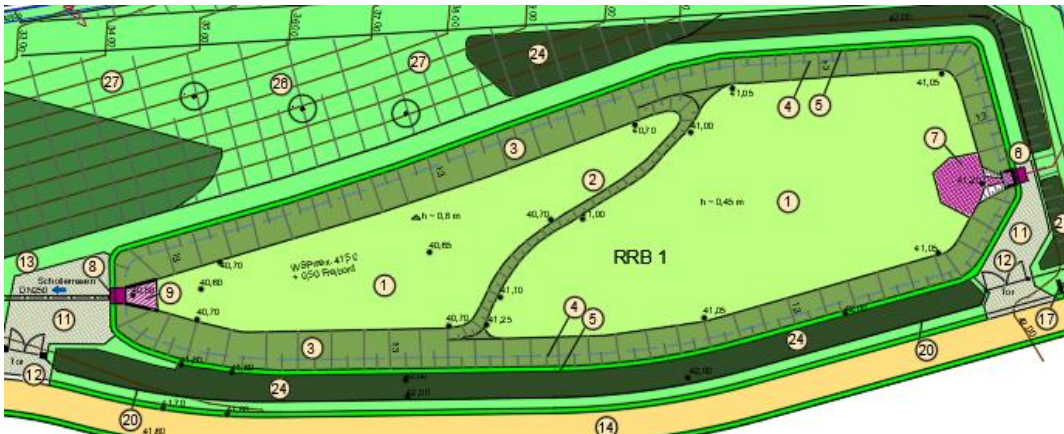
Planung RRB 1 (Auszug Plananlage C3_19)
